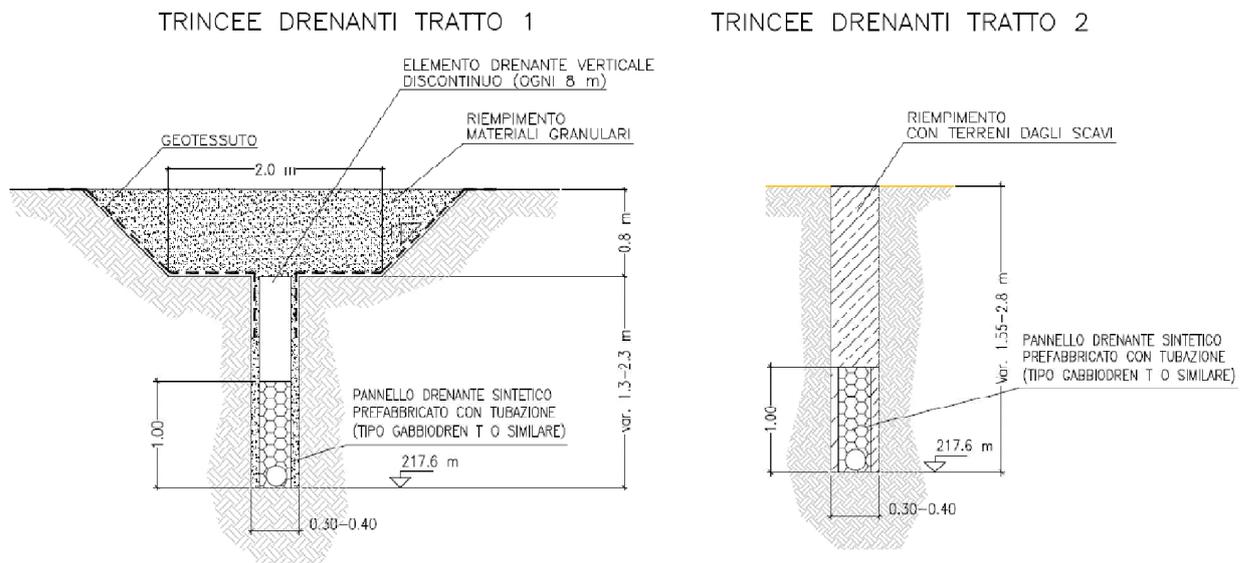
Sezioni tipiche della trincea drenante
